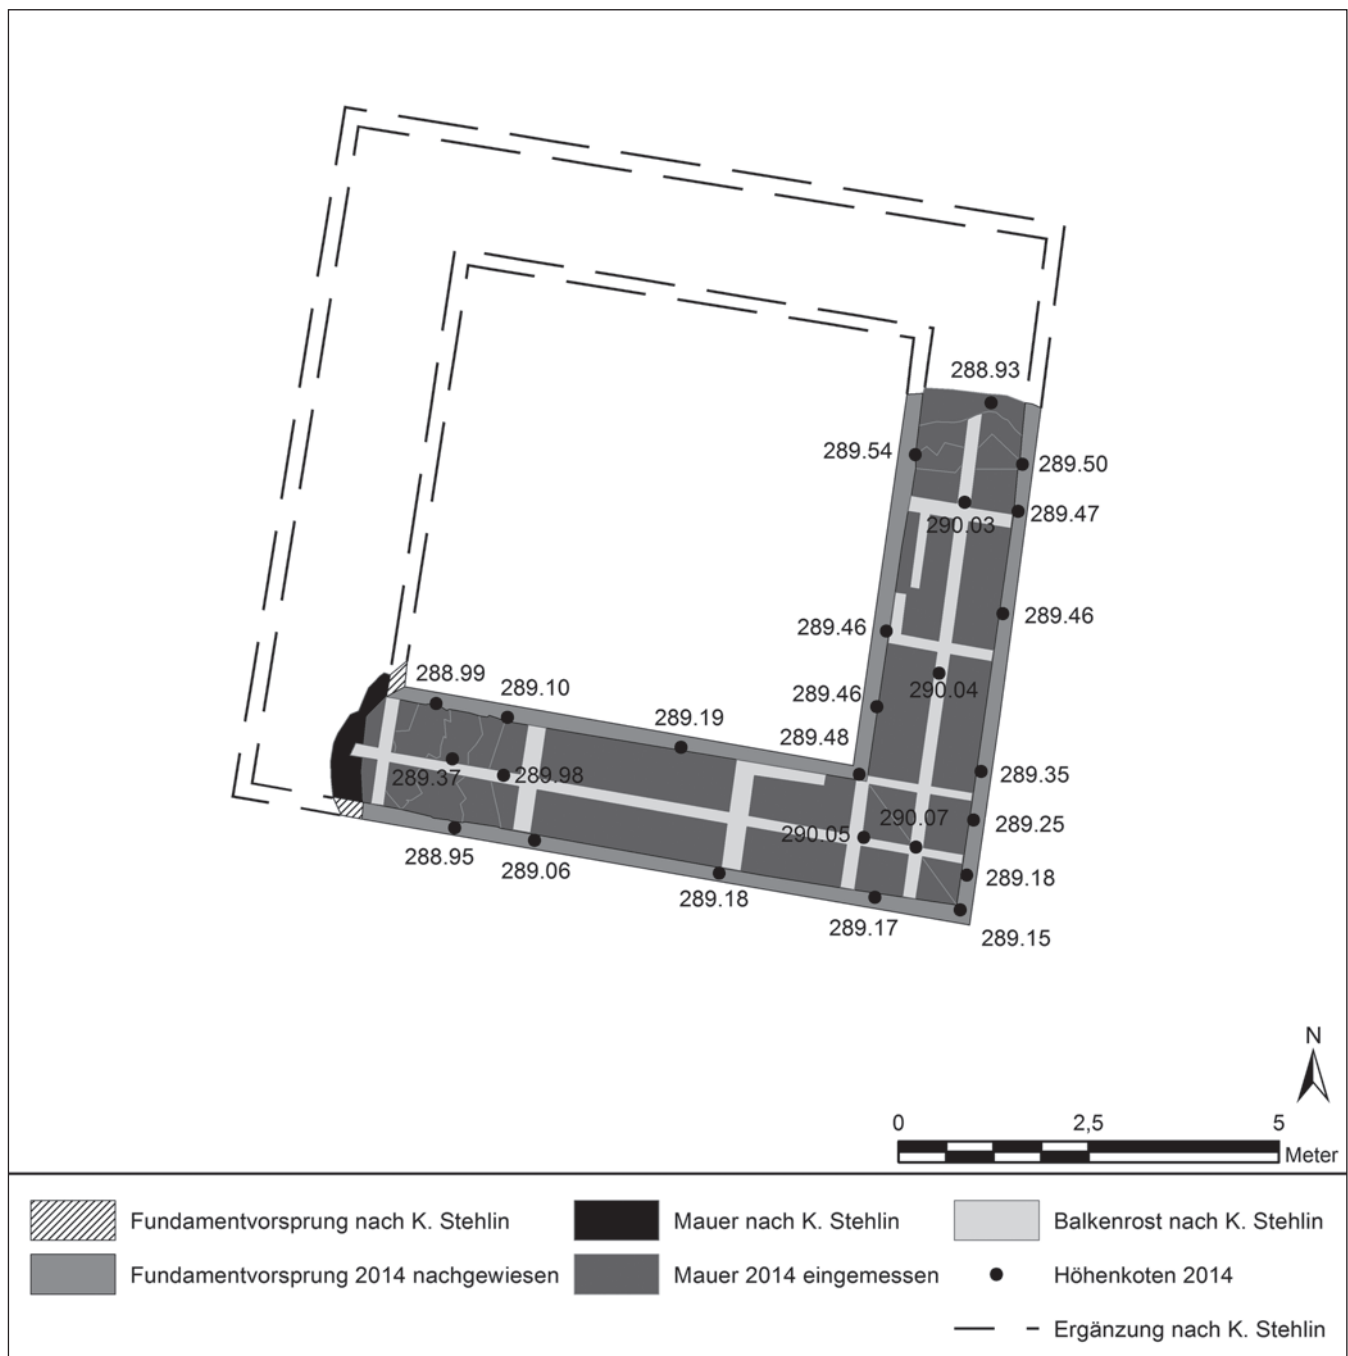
Möhlin-Fahrgraben (Mol.014.3). Im Rahmen der Sanierungsarbeiten neu vermessener und schematisch ergänzter Grundrissplan von K. Stehlin.
